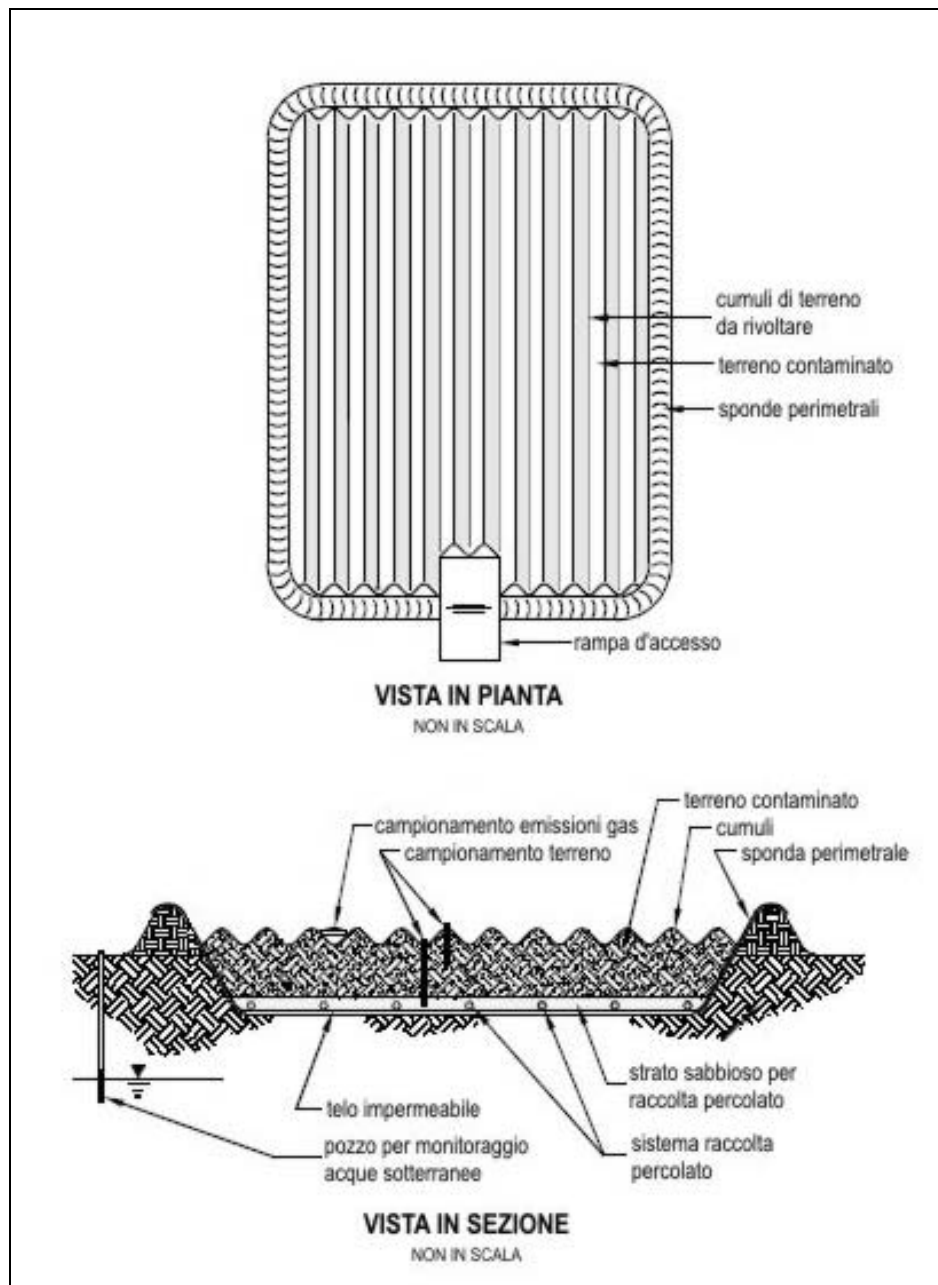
Esempio di progetto di una struttura per il landfarming.
